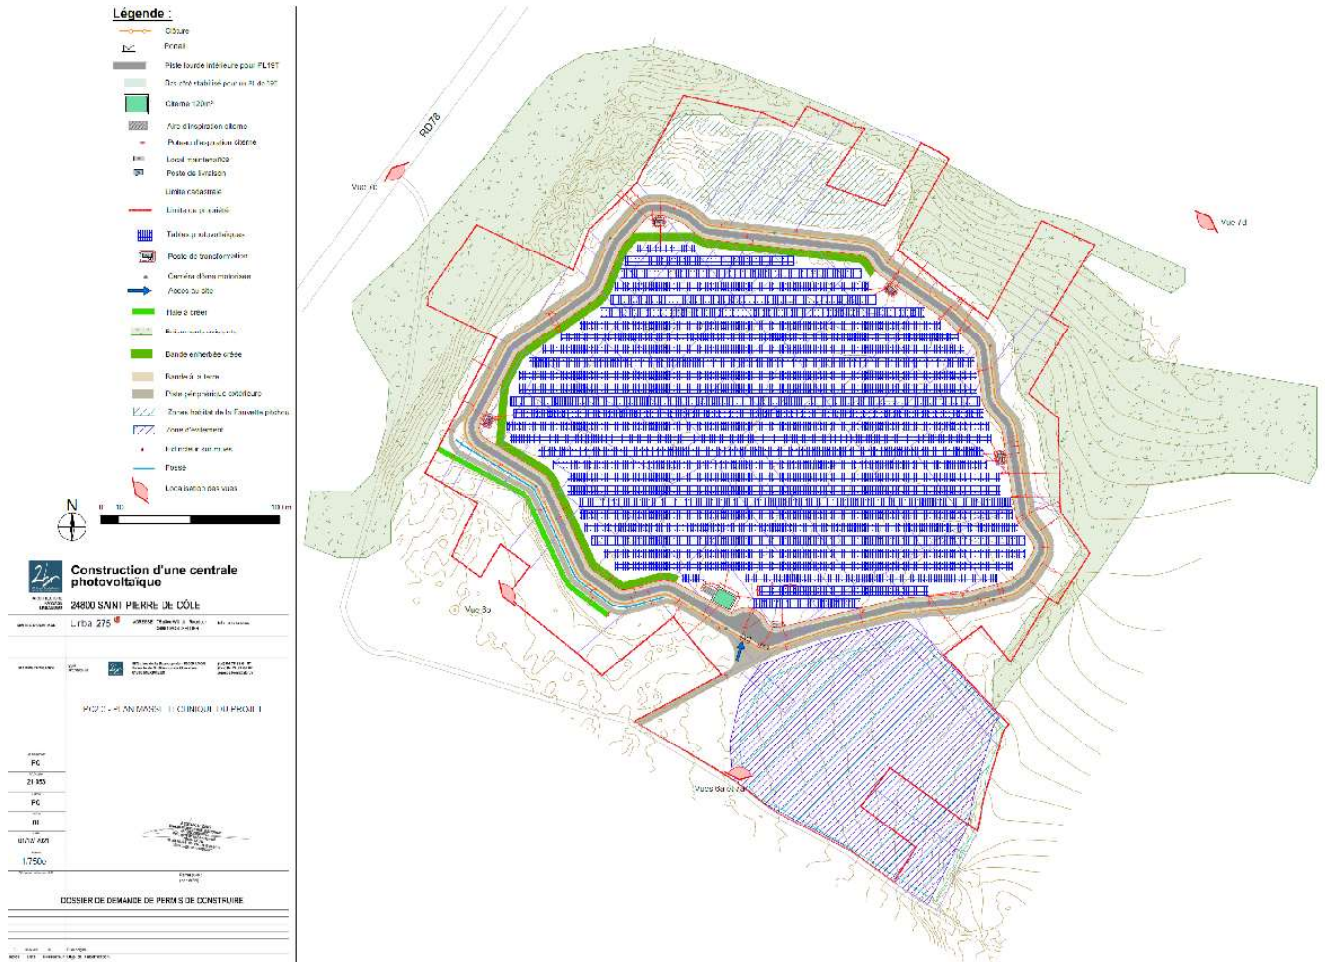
Plan de construction du projet de centrale photovoltaïque.
